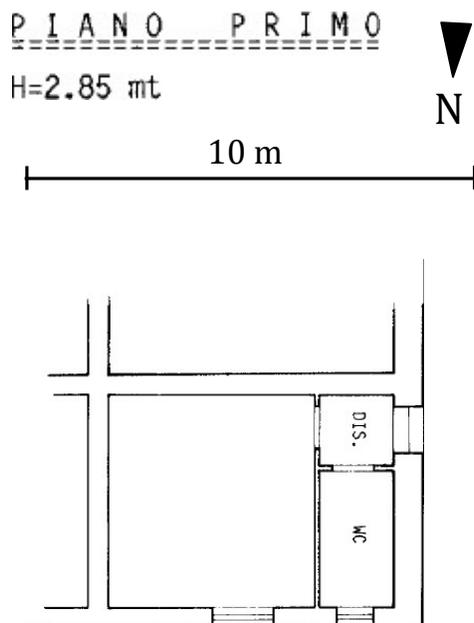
Estratto Planimetria Catastale - Abitazione di tipo popolare (Deposito/locale di sgombero) NCEU Foglio 29, Part. 1434 sub. 2
